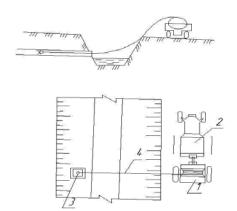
Схема промывки закрытого коллектора: I – дренопромывочная машина; 2 – трактор; 3 – устье; 4 – напорный шланг
